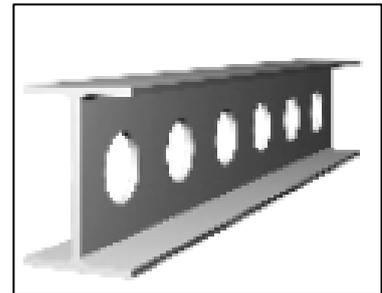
Poutre métallique alvéolaire (source : Google image)
